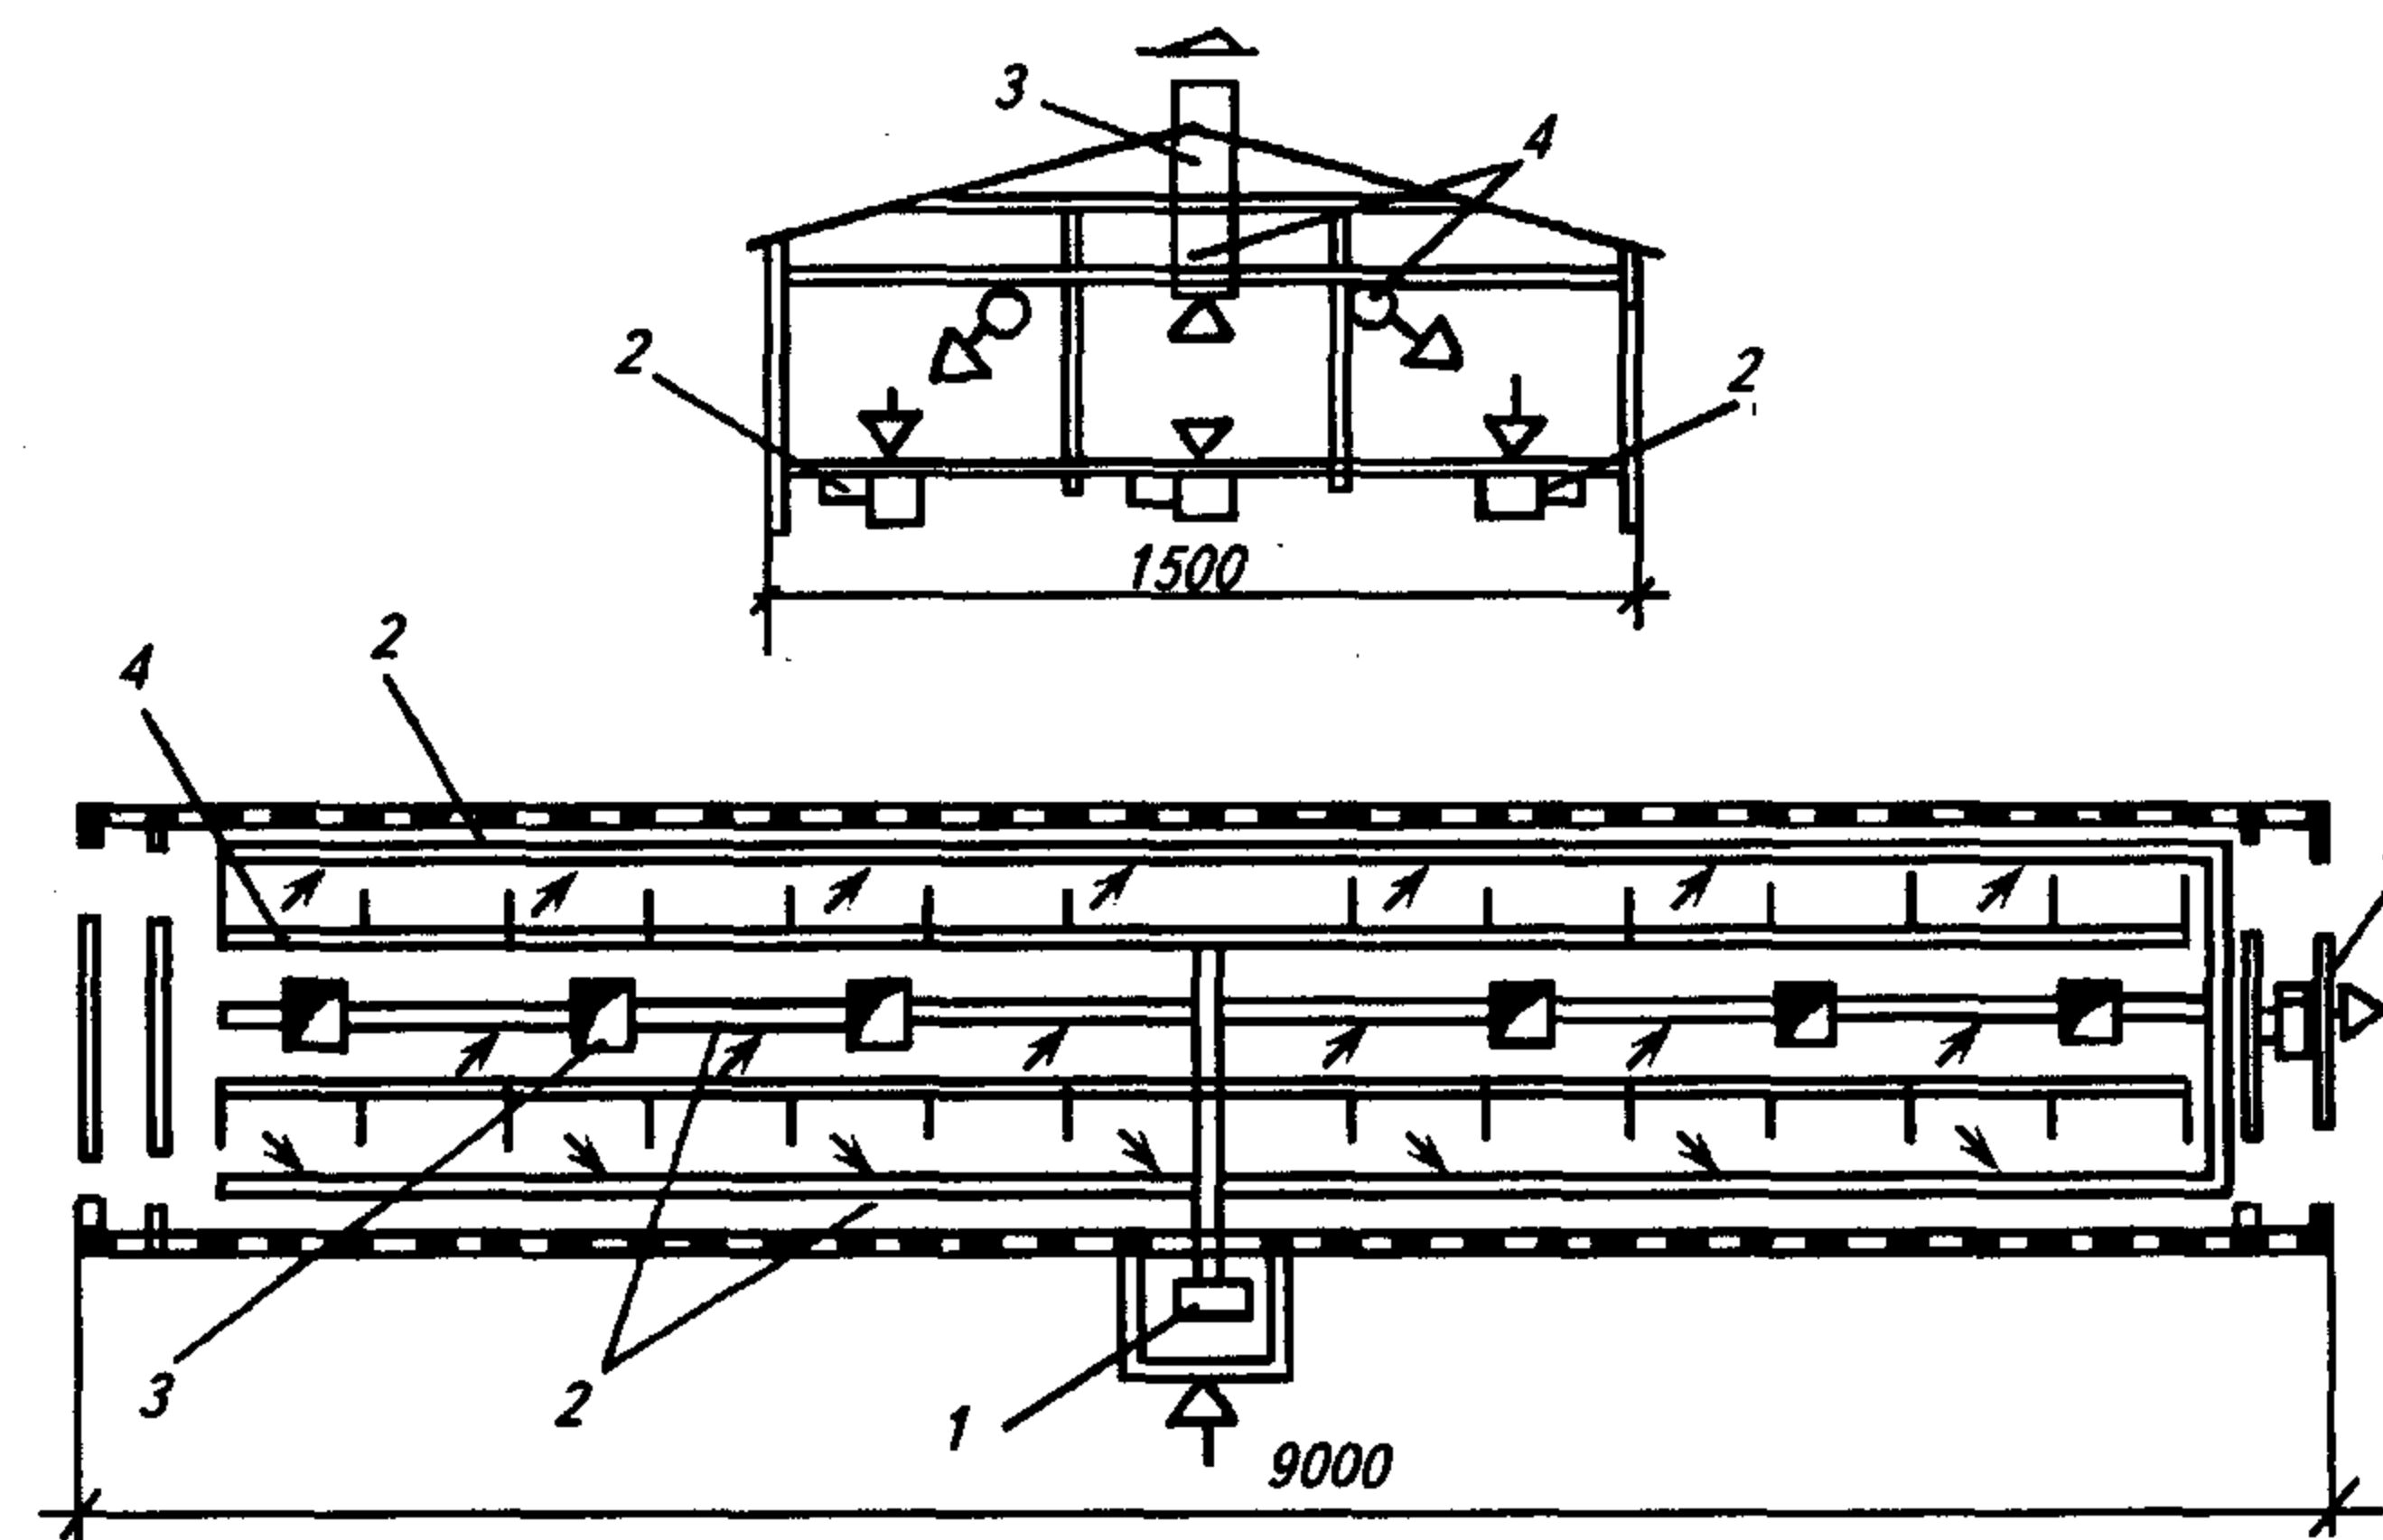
Система вентиляции помещений животноводческого здания:
